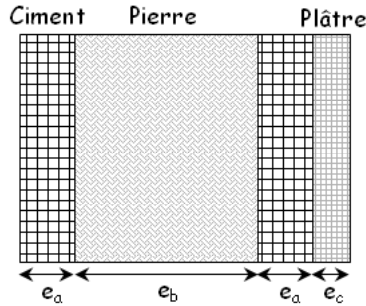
Couches constituant les murs Sud, Ouest de la salle du séjour et Est de la pièce.
